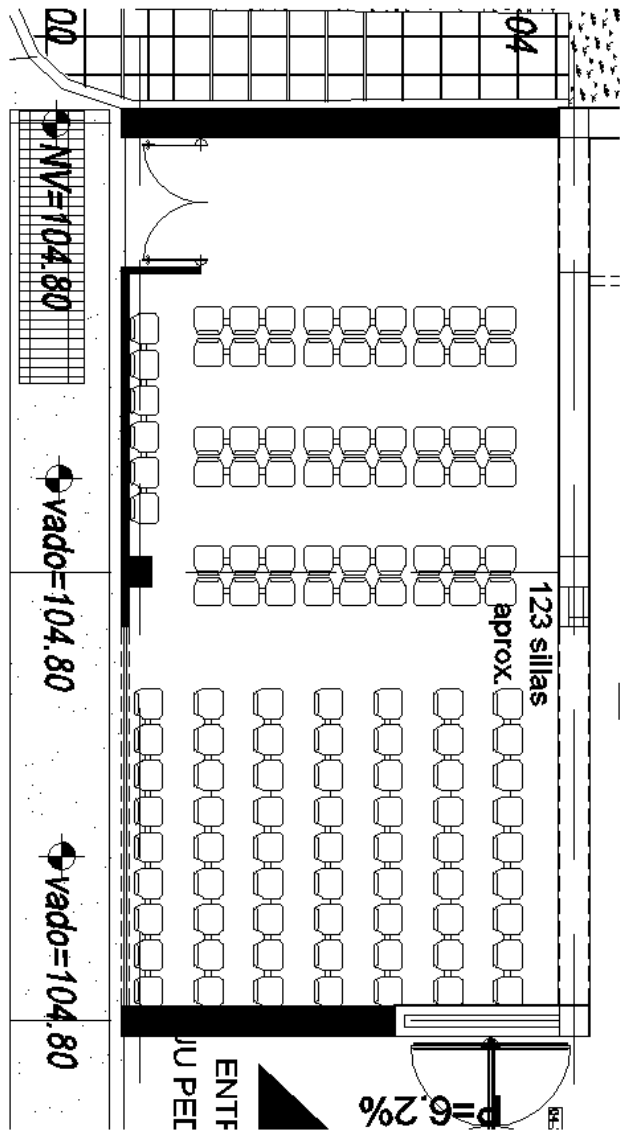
Lamina de plantas arquitectónicas de tomacorrientes
